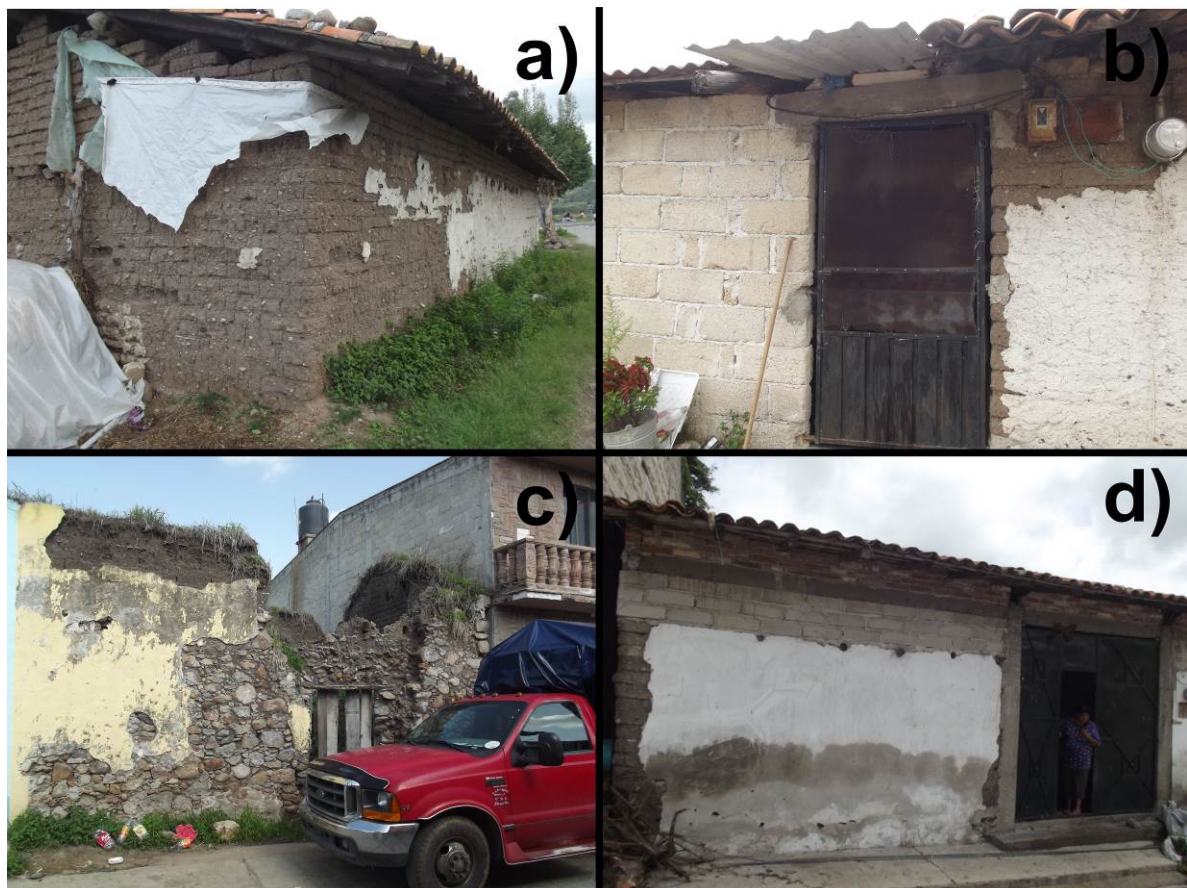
Tipos de muro en las viviendas de adobe de Malinaltenango. a) Muro de adobe; b) Muro de adobe-bloque de hormigón; c) Muro de adobe-piedra; y d) Muro de adobe-bloque de hormigón-ladrillo.
